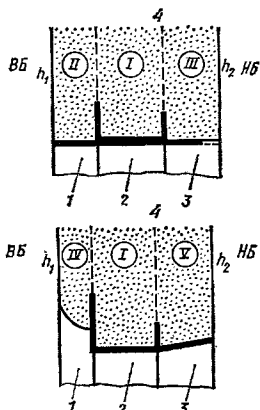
Схемы сопряжения бетонной плотины с земляной
